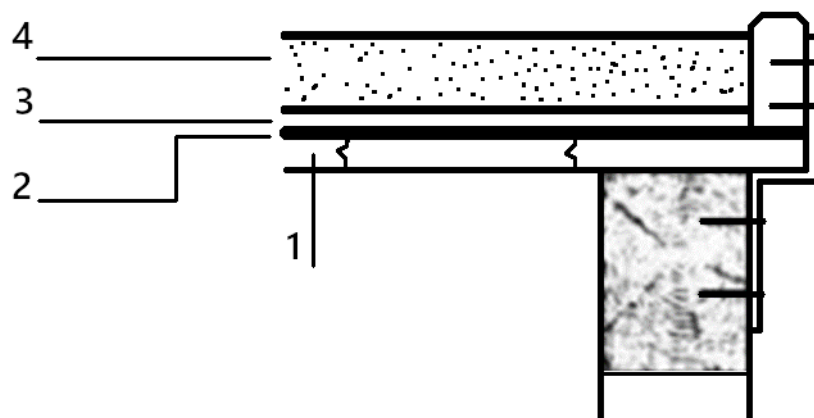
Detalle del sistema constructivo *Holzzementdach*. Leyenda: 1. Forjado de madera sin aditivos; 2. Lámina impermeable (4 capas); 3. Arena (15 mm); 4. Grava (60-100 mm).
